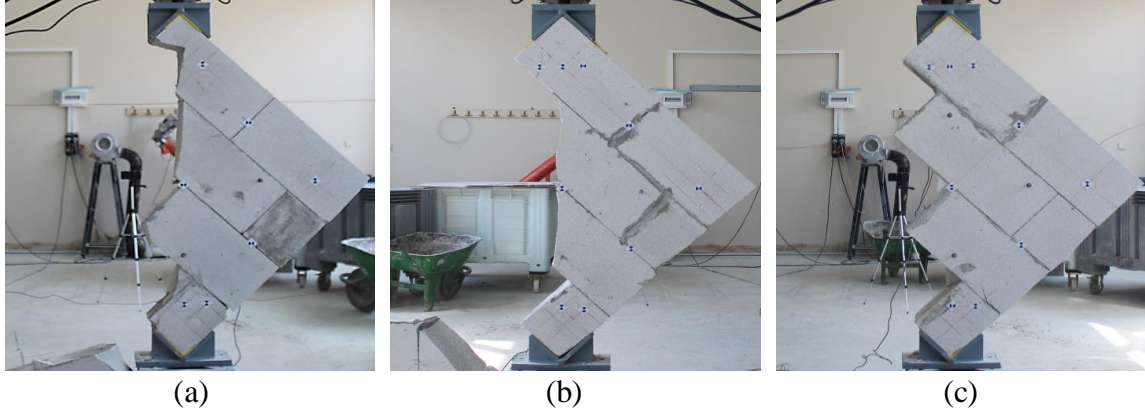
75x75 cm boyutlarındaki numunelerde oluşan hasarların karşılaştırılması (a) 75-1, (b) 75-2 ve (c) 75-3
